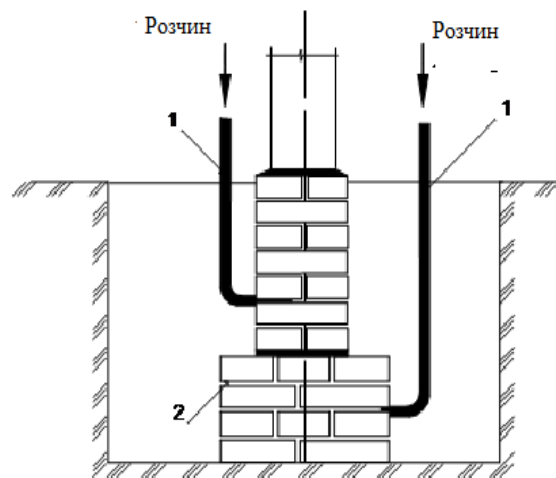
Зміцнення кладки старого фундаменту:
